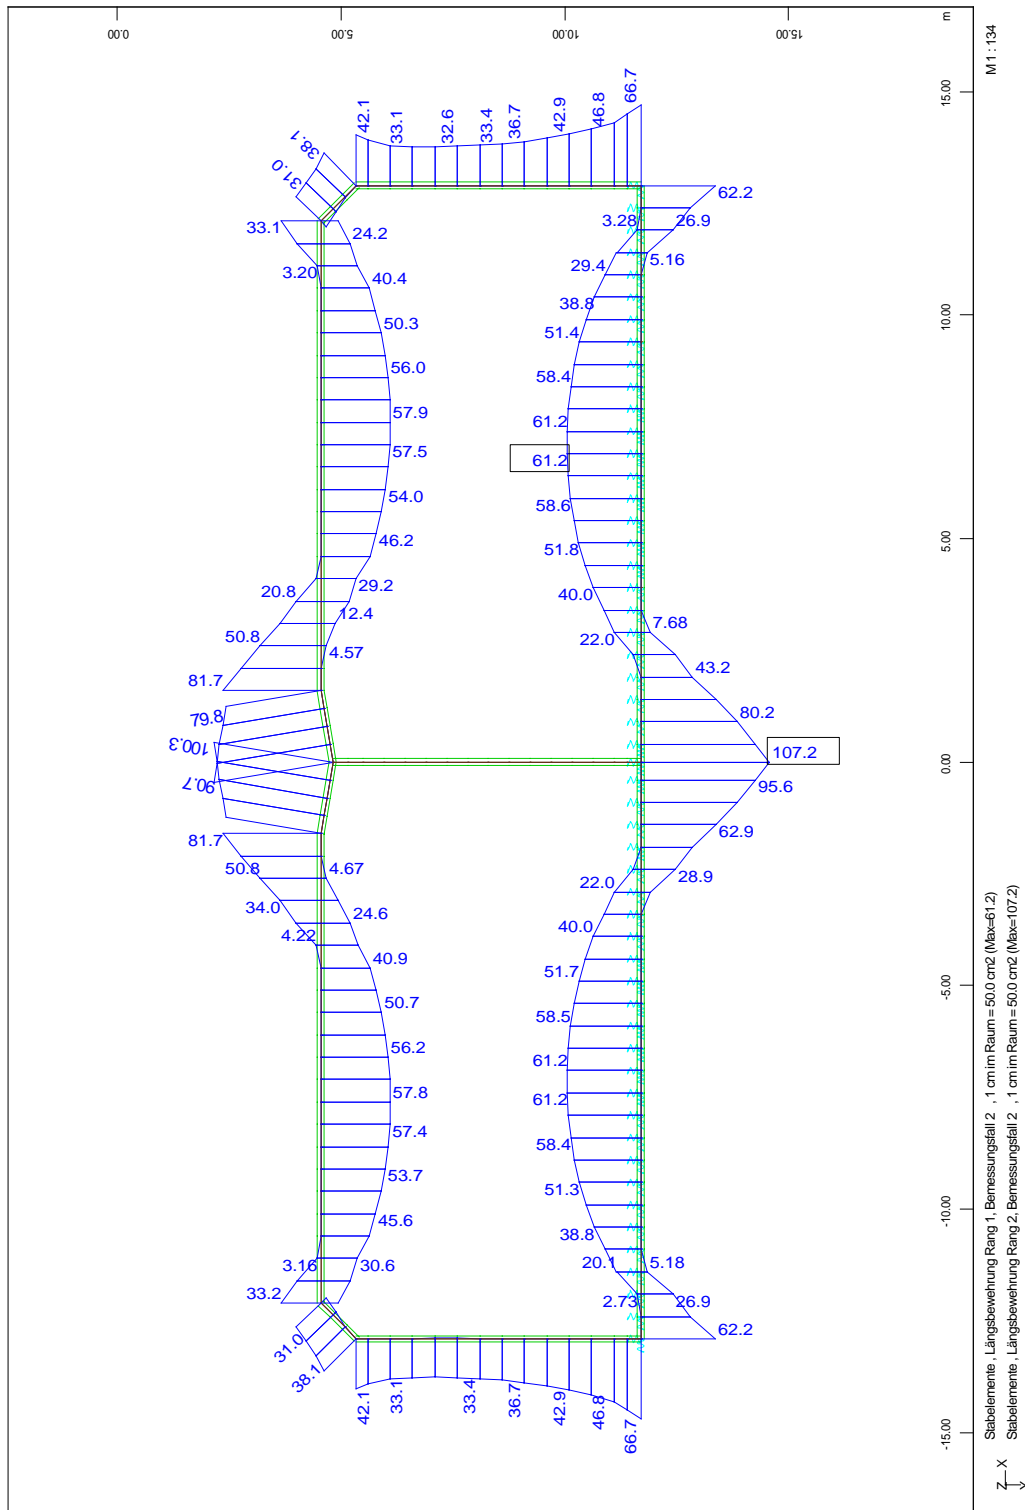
Biegebewehrung zur Rissbreitenbeschränkung
